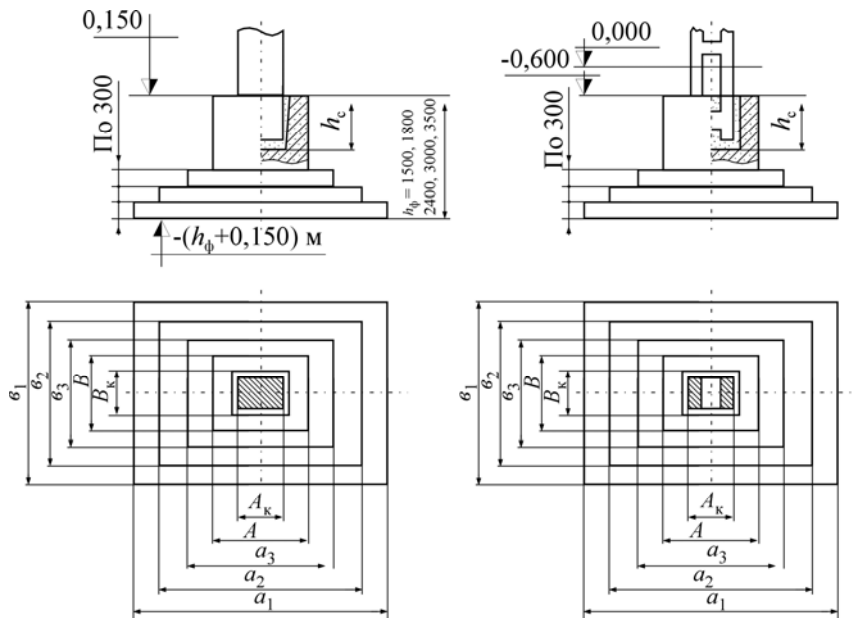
Різновиди фундаментів підколони промислових будівель
